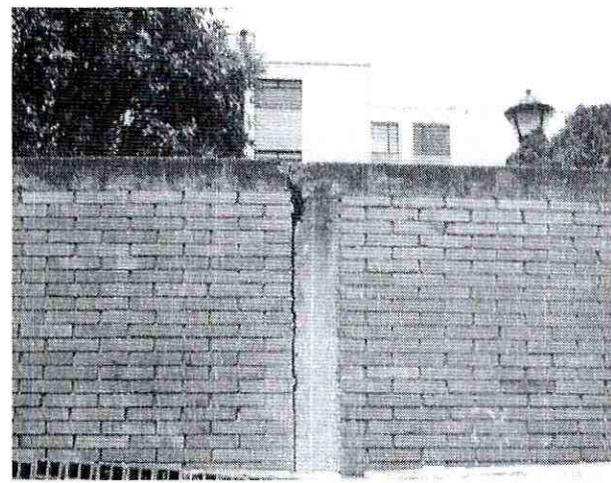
Sección del muro en mampostería confinada por columnas y vigas en concreto reforzado, evidencia de la pérdida de verticalidad
